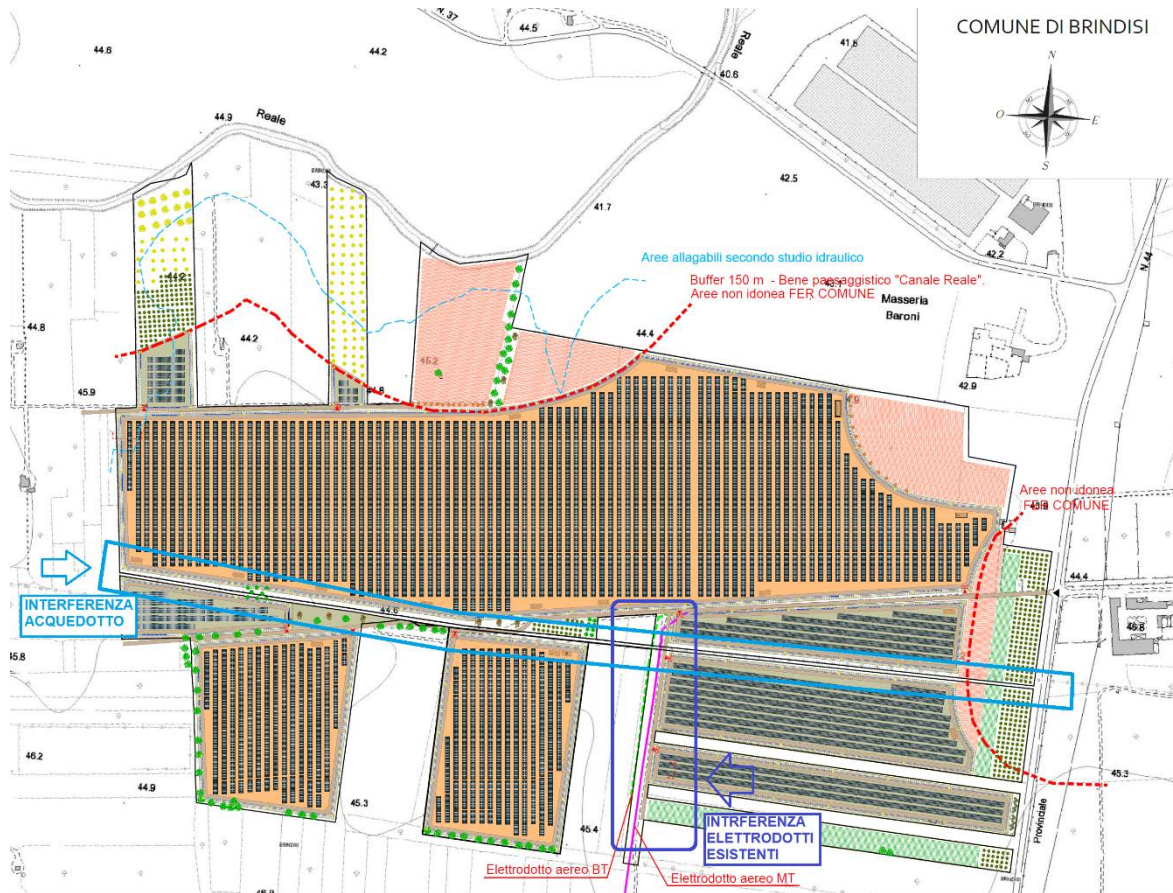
Layout impianto con indicazione della condotta dell'Acquedotto e delle linee aree MT e BT.
